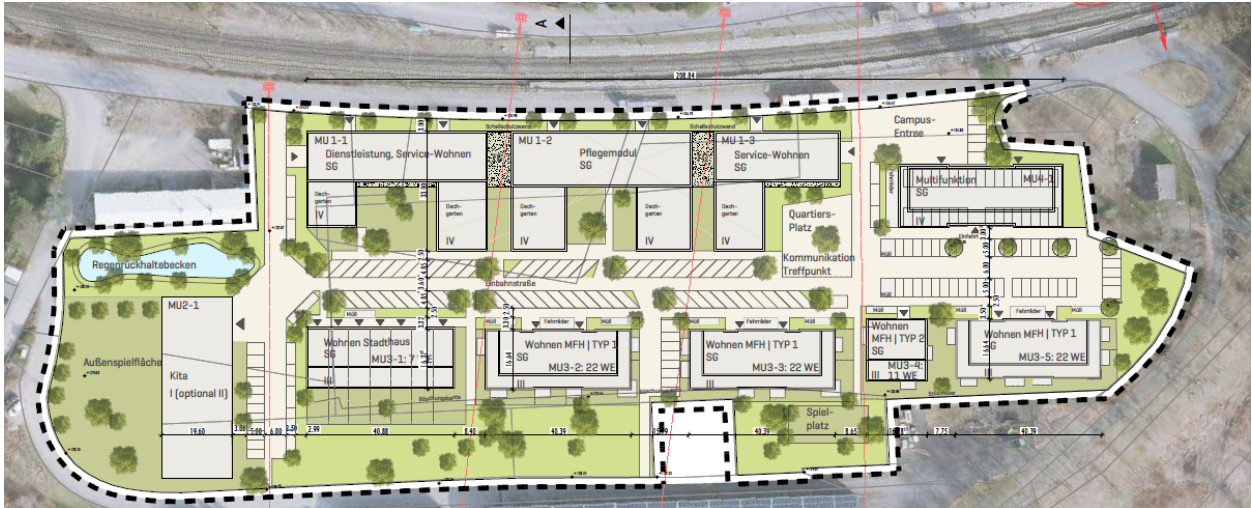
Lageplan im Entwurf [Quelle: TERNES architekten BDA]
